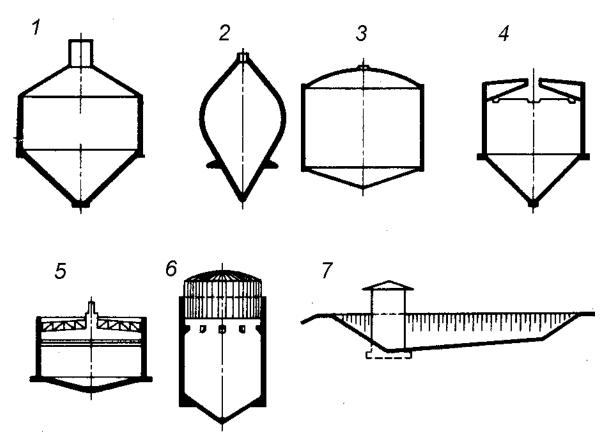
Конструкции метантенков: 1-3-c неподвижным незатопленным перекрытием; 4-c неподвижным затопленным перекрытием; 5-6-c подвижным (плавающим) перекрытием; 7-oткрытый.
